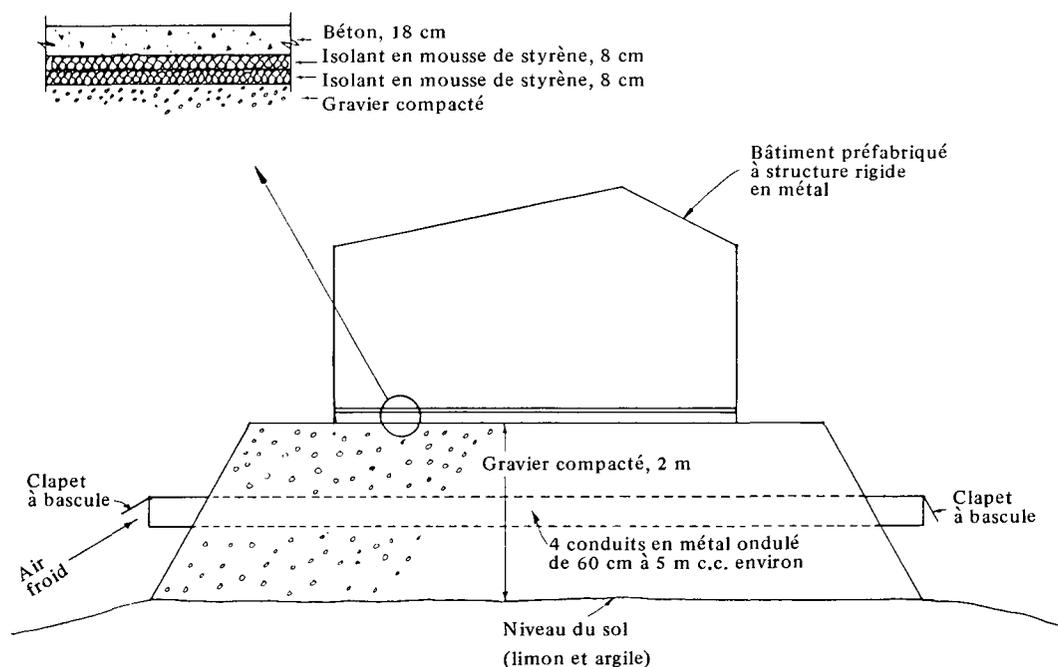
Fondations et plancher de la nouvelle usine de traitement de l'eau
